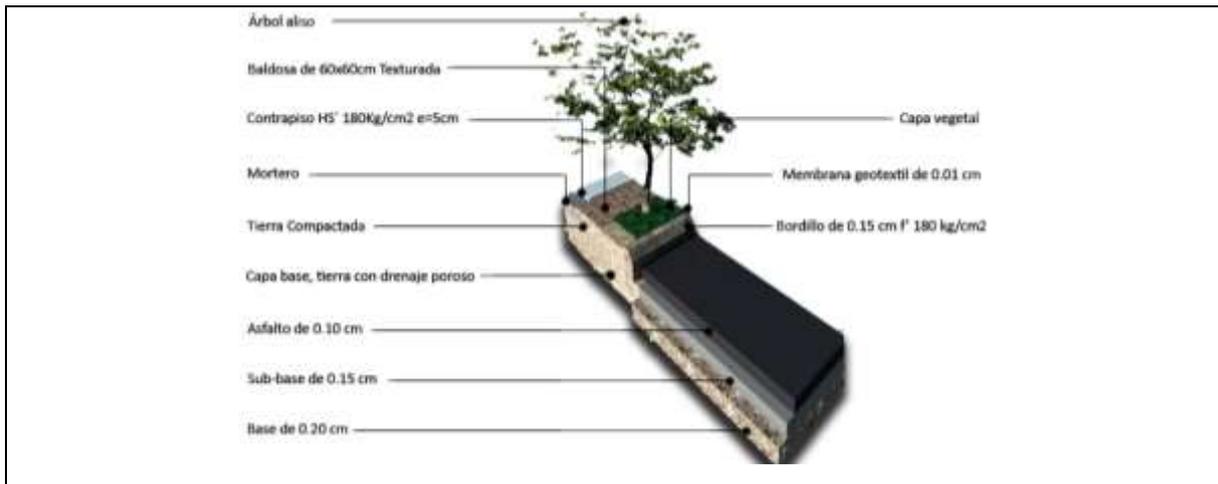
Corte Planta de la calle Juan José Samaniego
